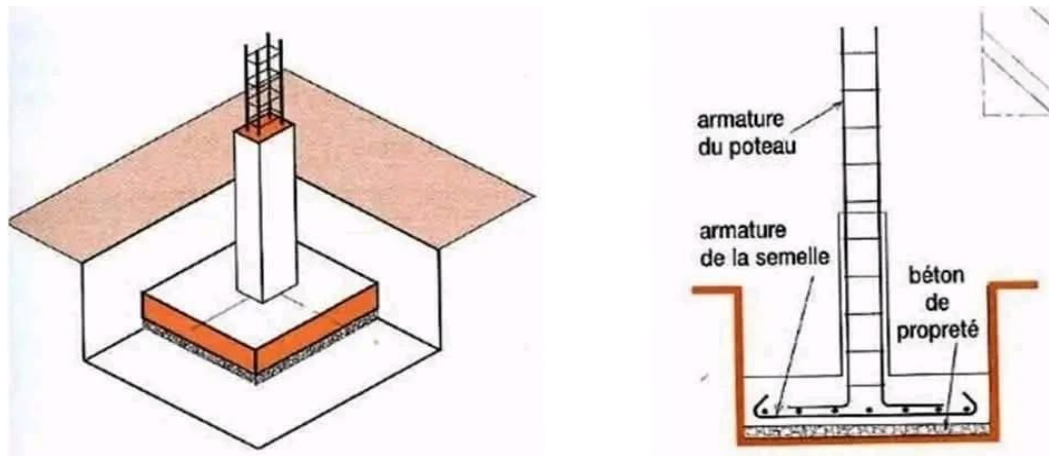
Semelle isolée sous poteau en BA et coupe transversale sur semelle et poteau
